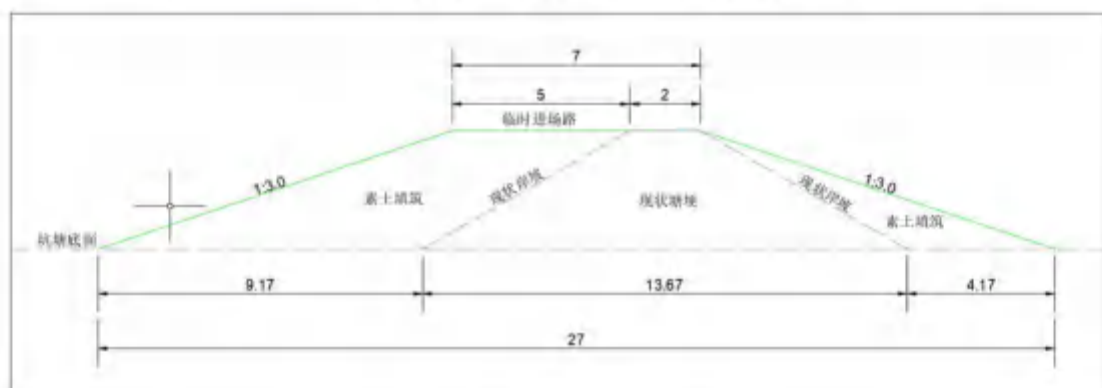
临时路典型断面图（单位：cm）
